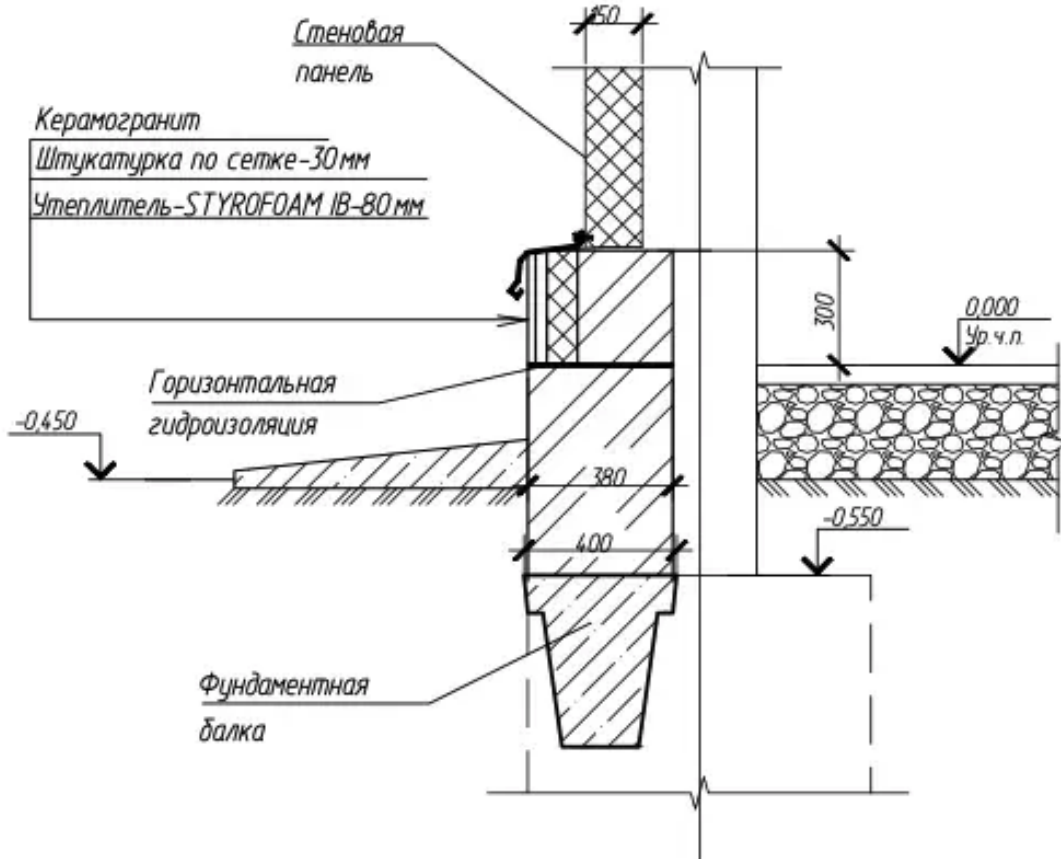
Узел примыкания стеновой панели к фундаменту
